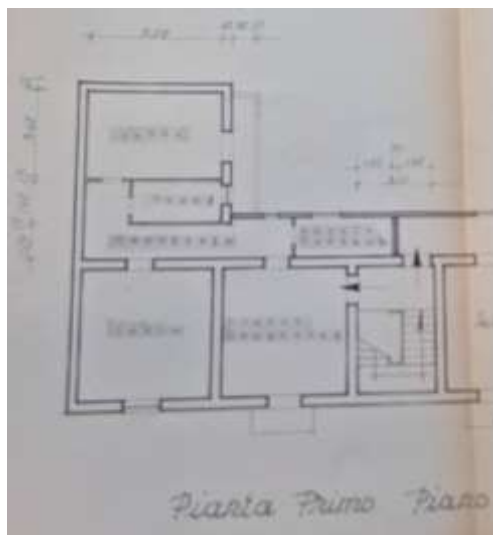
planimetria dell'appartamento al primo piano secondo la C.E. n.31/94
